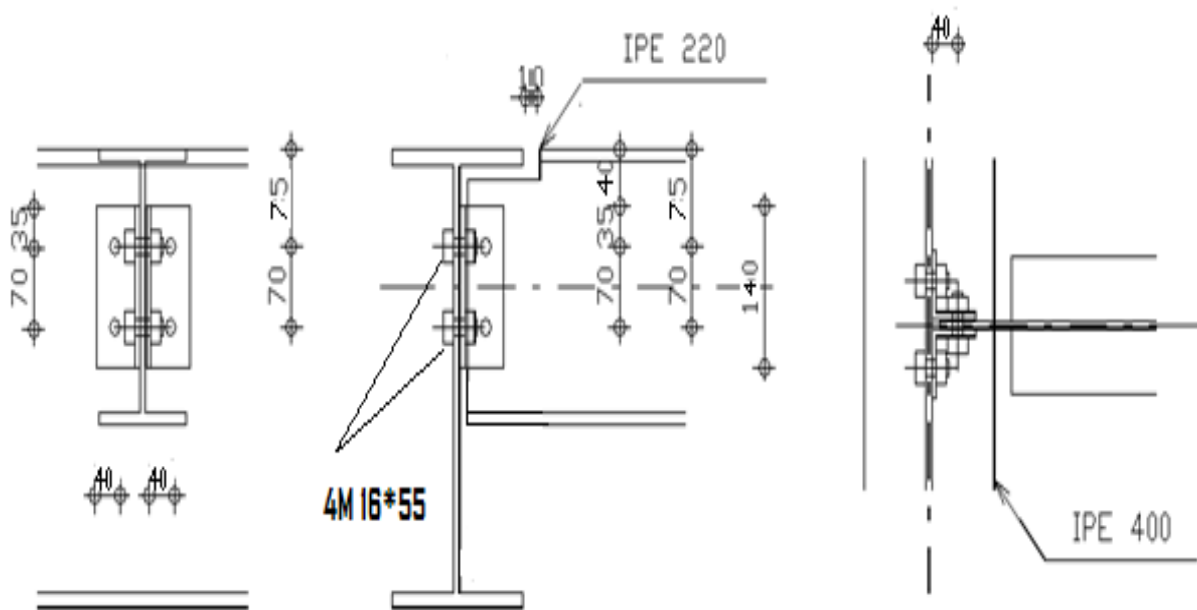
Détail d'assemblage Poutre principale – Solive
